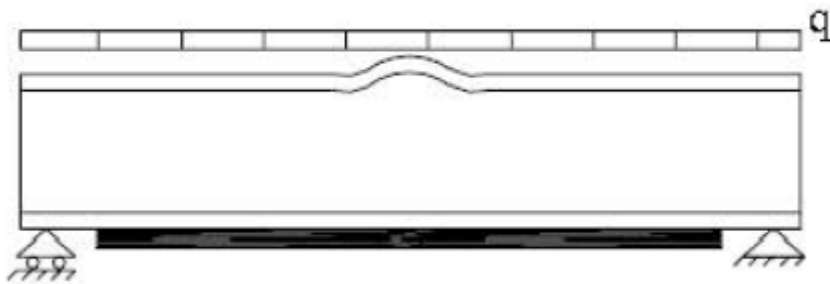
Потеря местной устойчивости сжатого пояса балки
